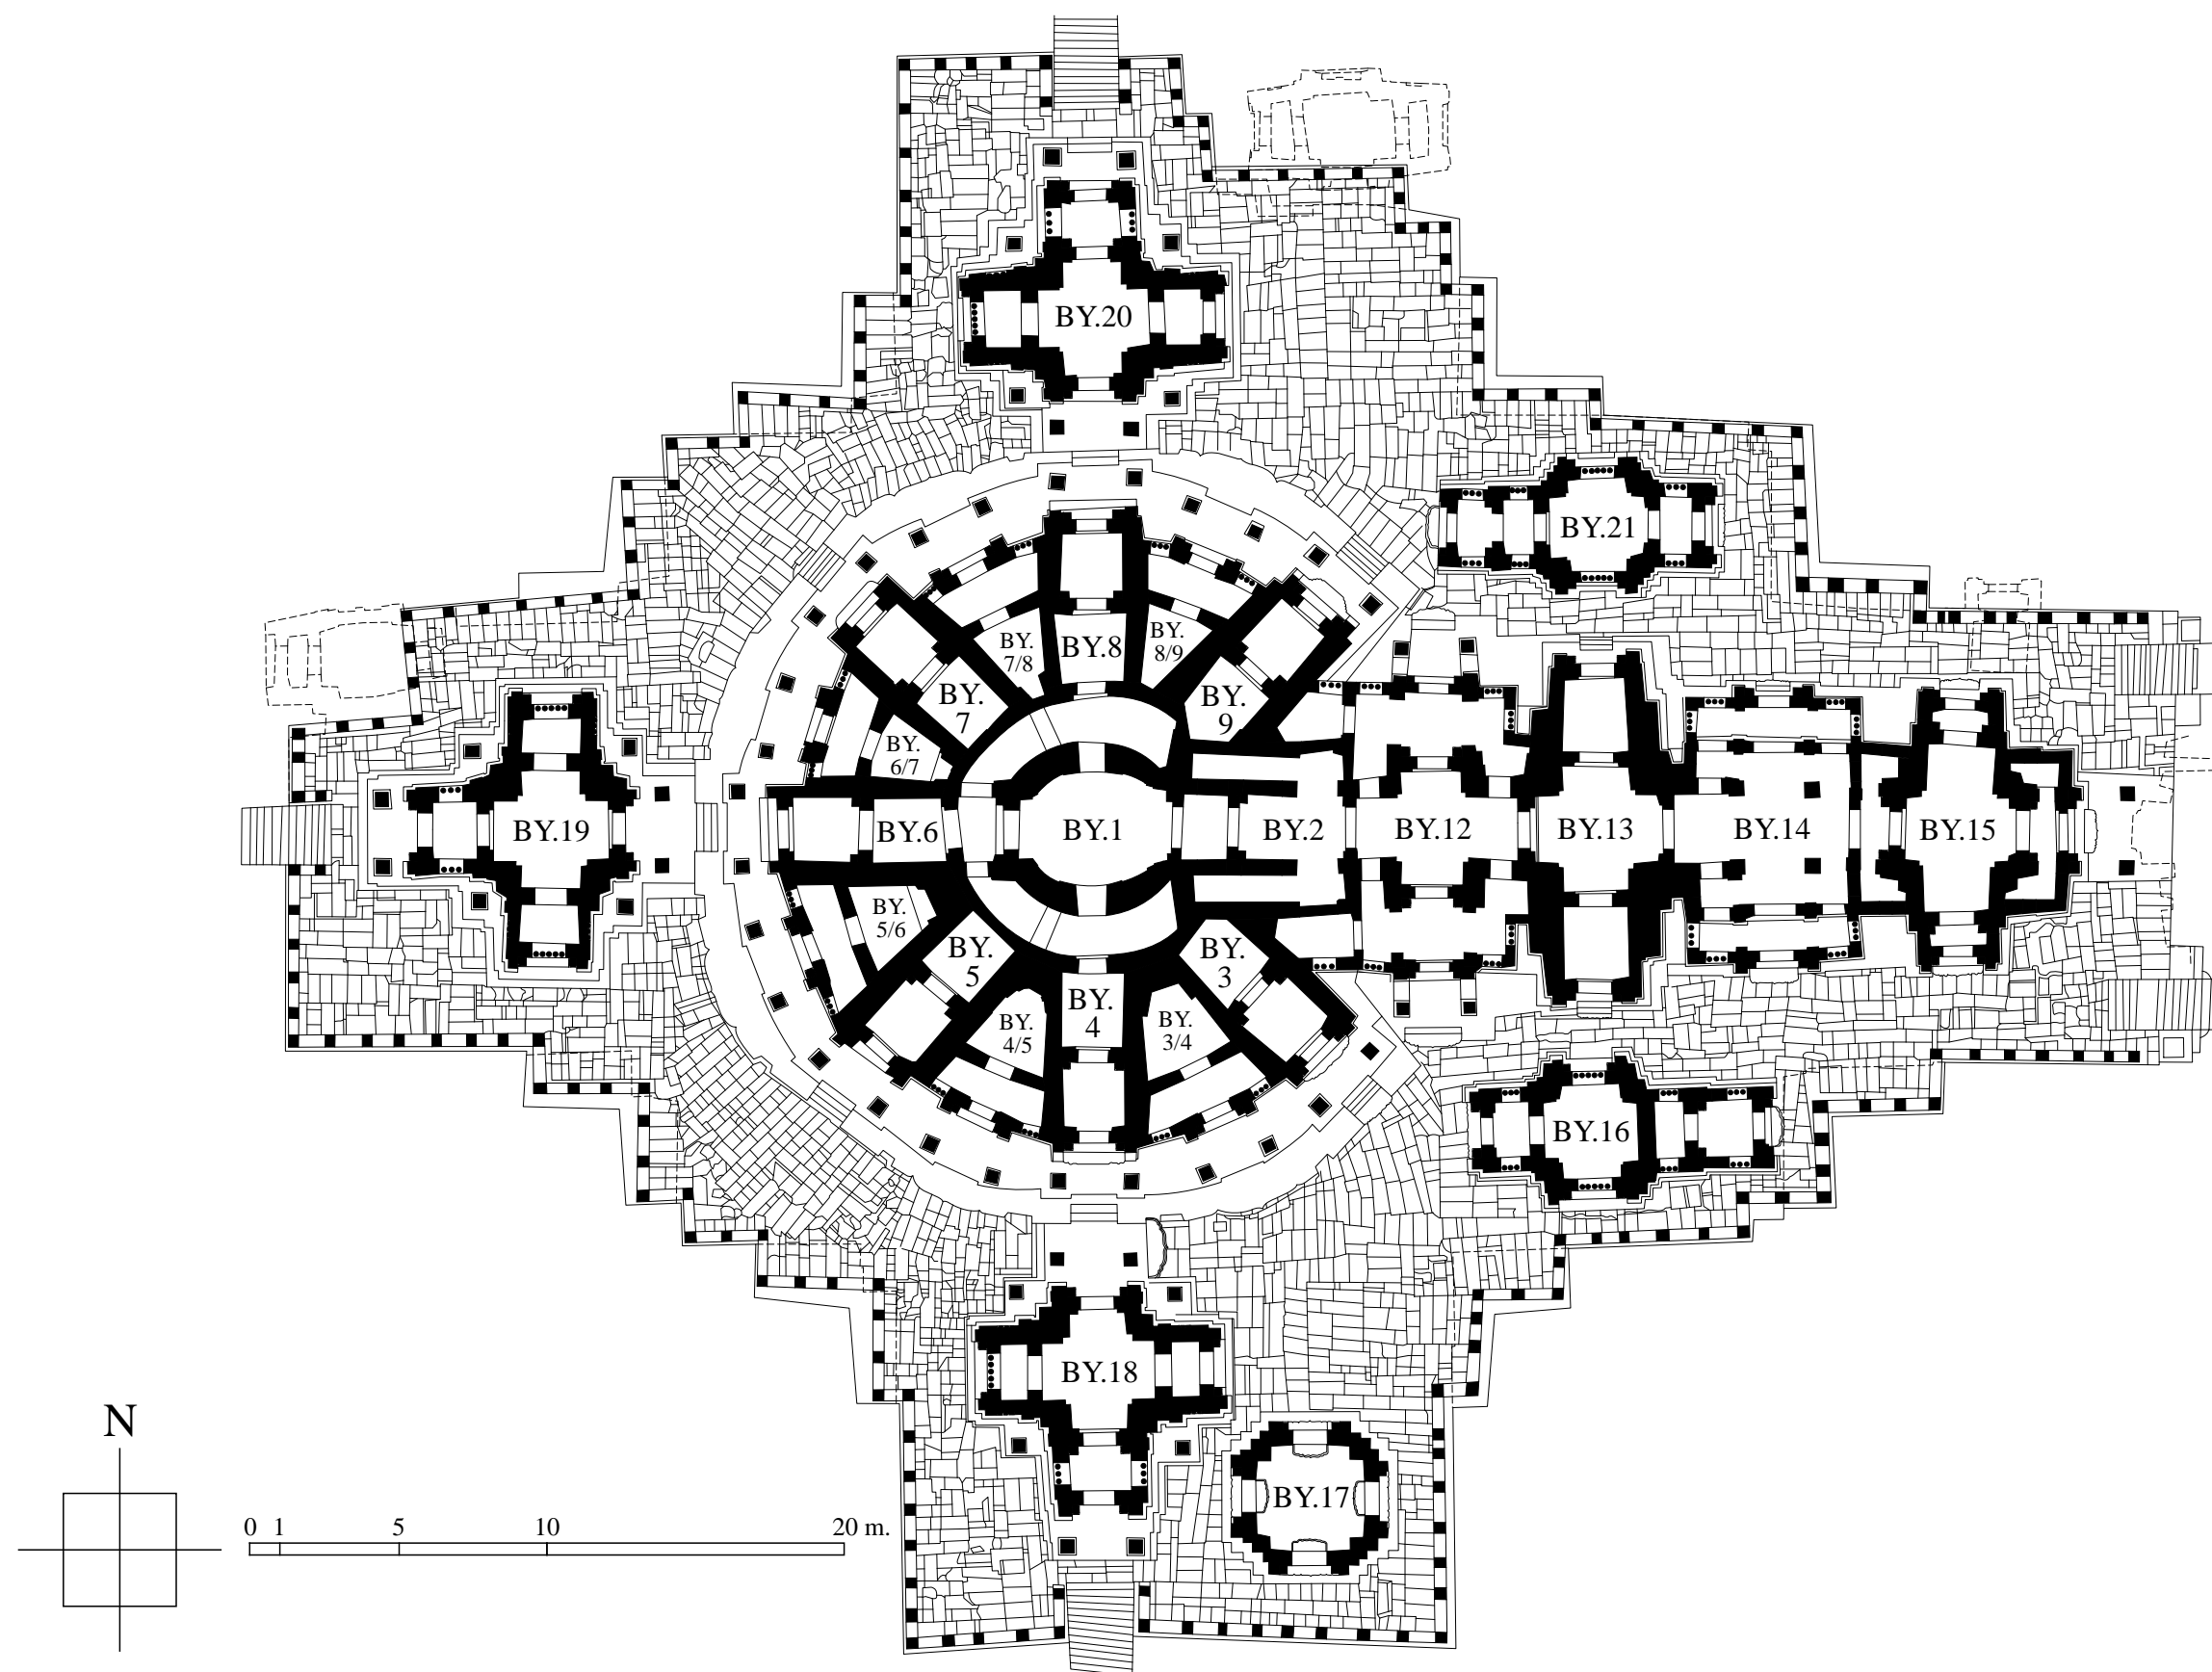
Plan du troisième étage du Bayon
